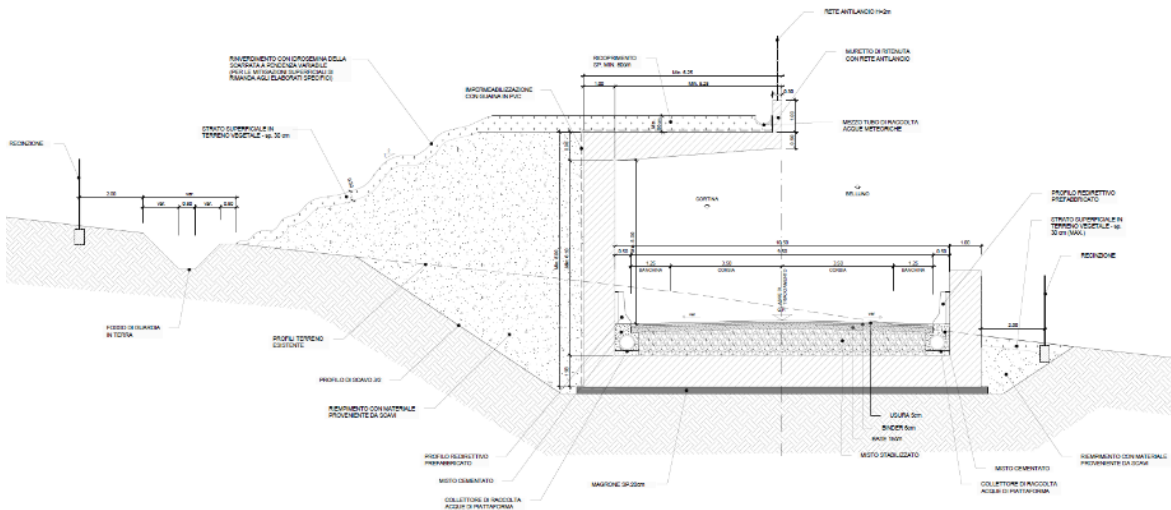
Asse Principale - Sezione tipo in galleria artificiale semi aperta
